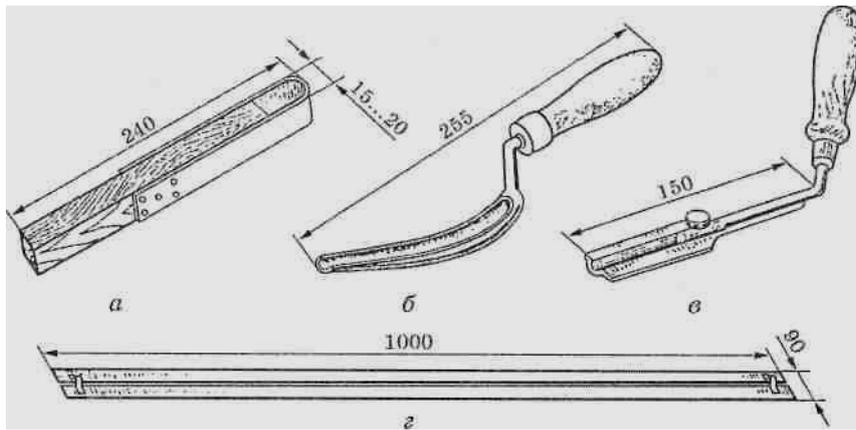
Інструменти і пристрої для виконання рустів: *а*— рустовка; *б*— розшивка; *в* — розшивка зі змінними лезами; *г*— лінійка
